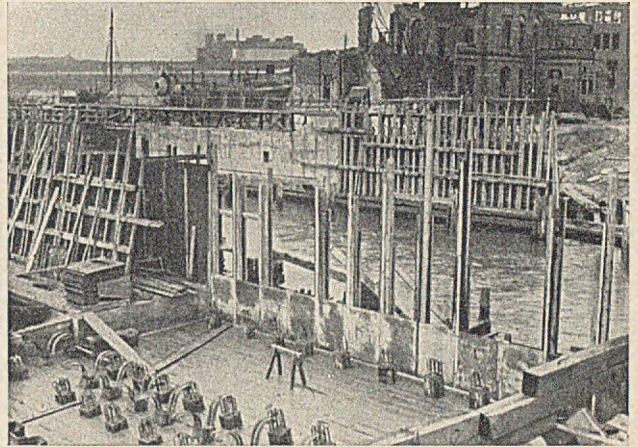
c). Blick auf die Baustelle (im Vordergrund Ausführung b, am anderen Ufer Ausführung a in Stahlschalung).
